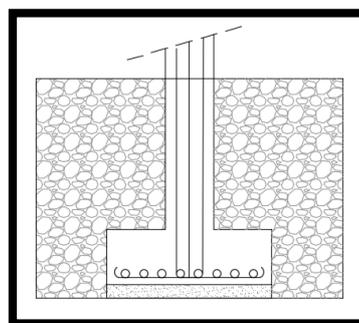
détail 1 articulation pied de poteau-fondation. Source : auteur
